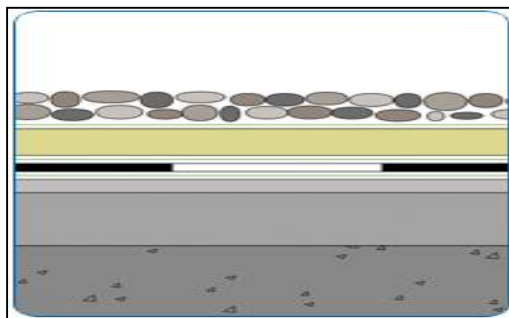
Detalle constructivo de una cubierta plana no transitable con grava invertida.
